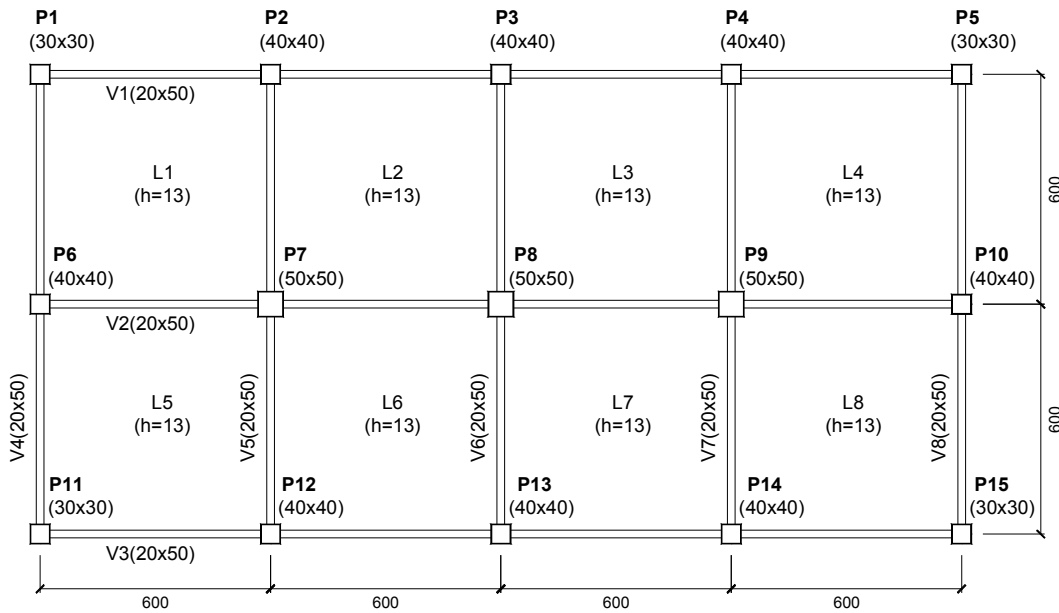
Planta de formas estruturais dos pavimentos (medidas em cm)
